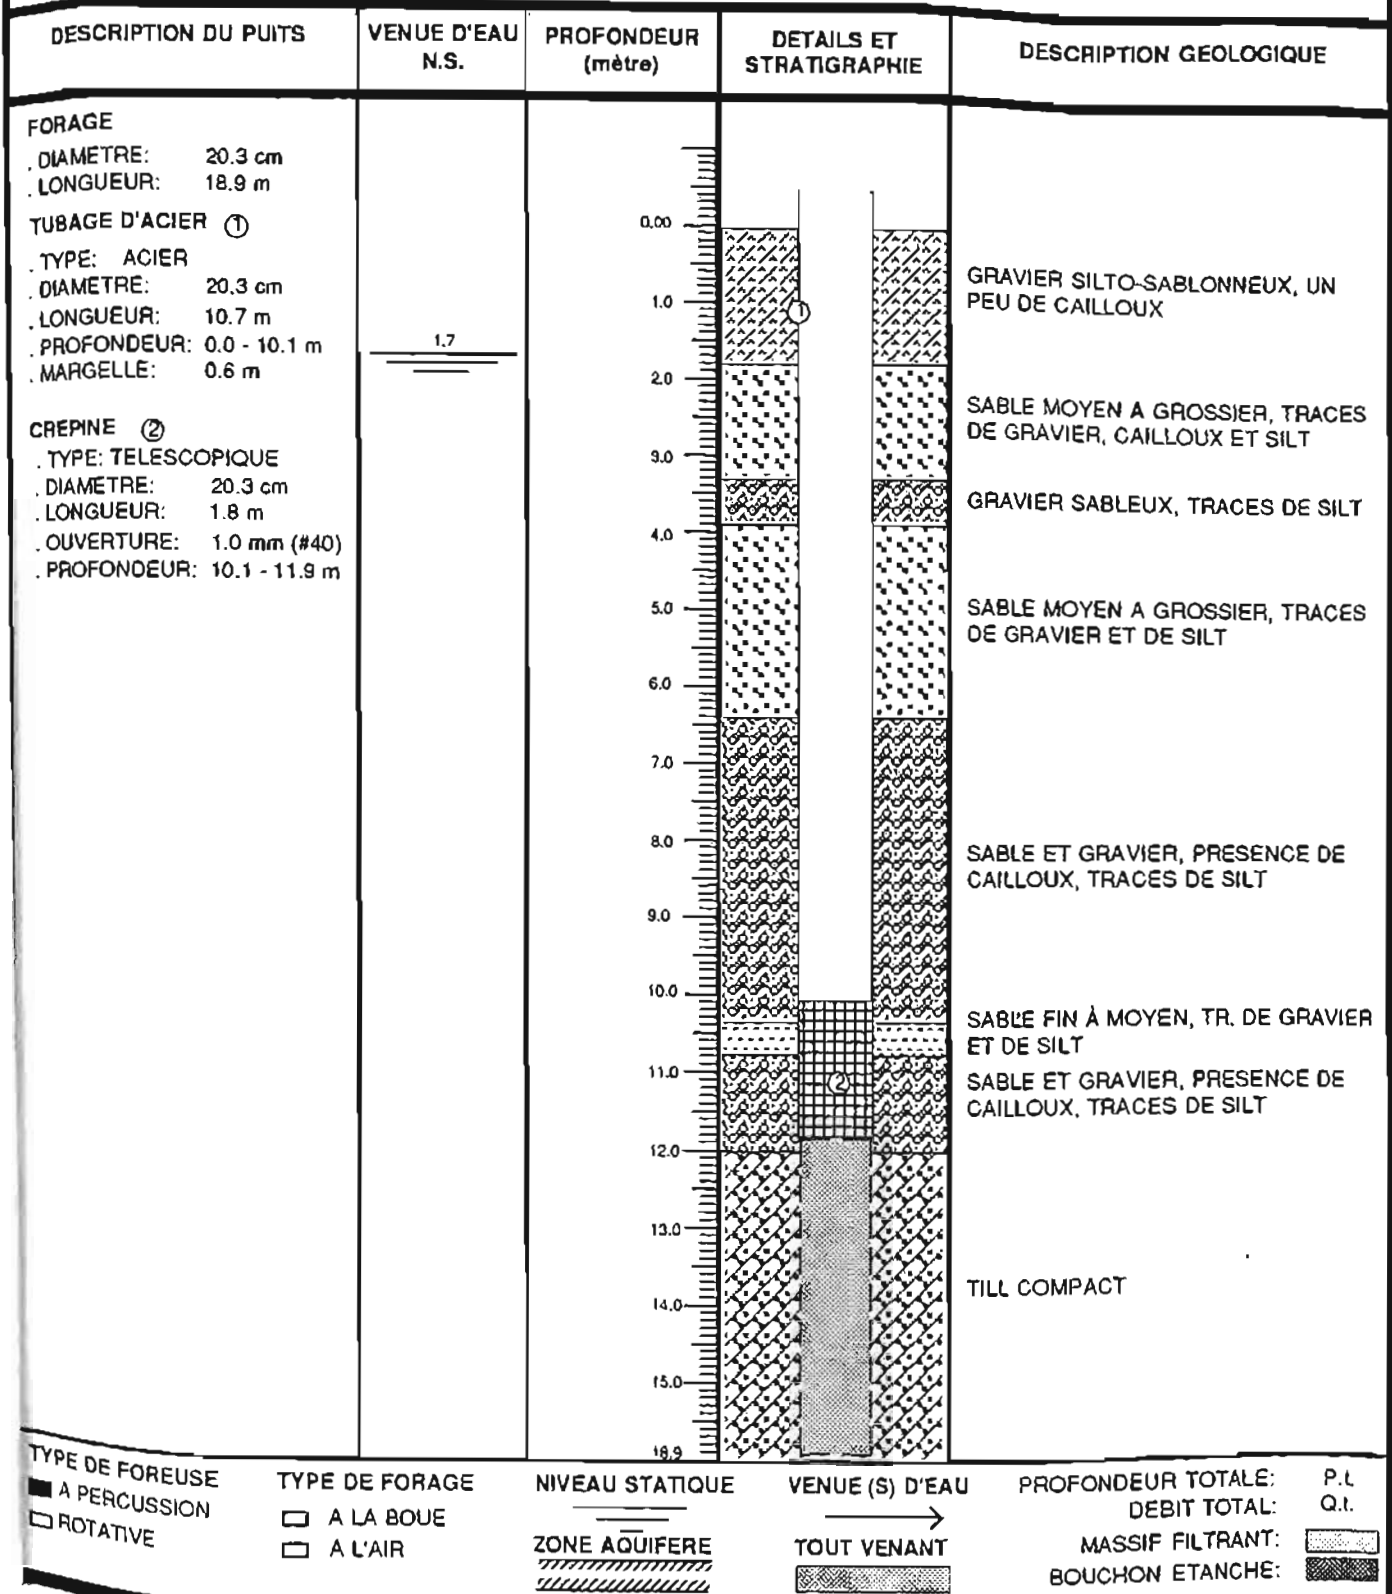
SCHEMA D'INSTALLATION DU PUIT D'ESSAI PE-1
